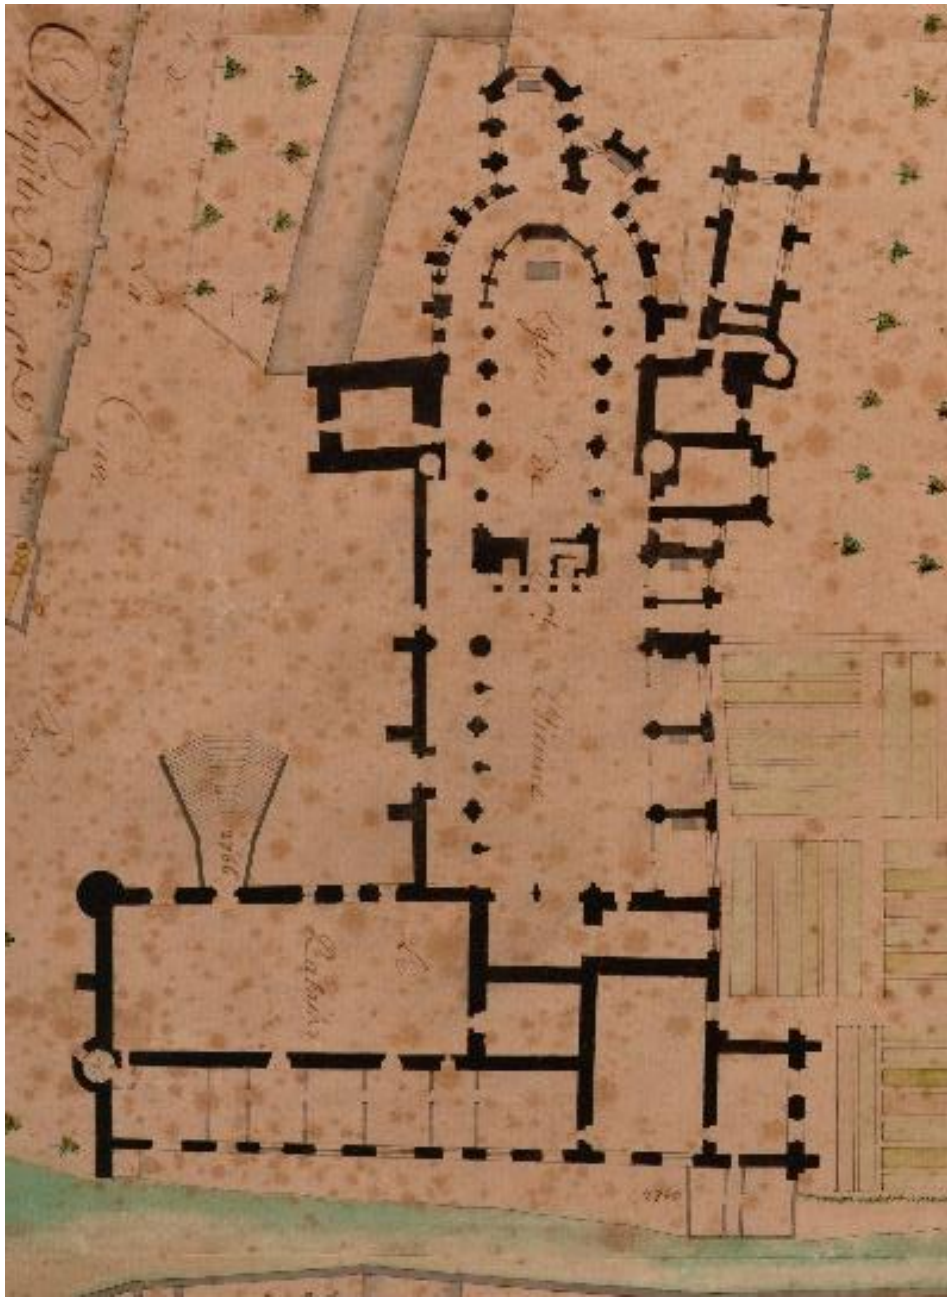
Extrait du plan au 1/286^e de l'ingénieur des ponts et chaussées Jean-Joseph Bochet de Coluel
